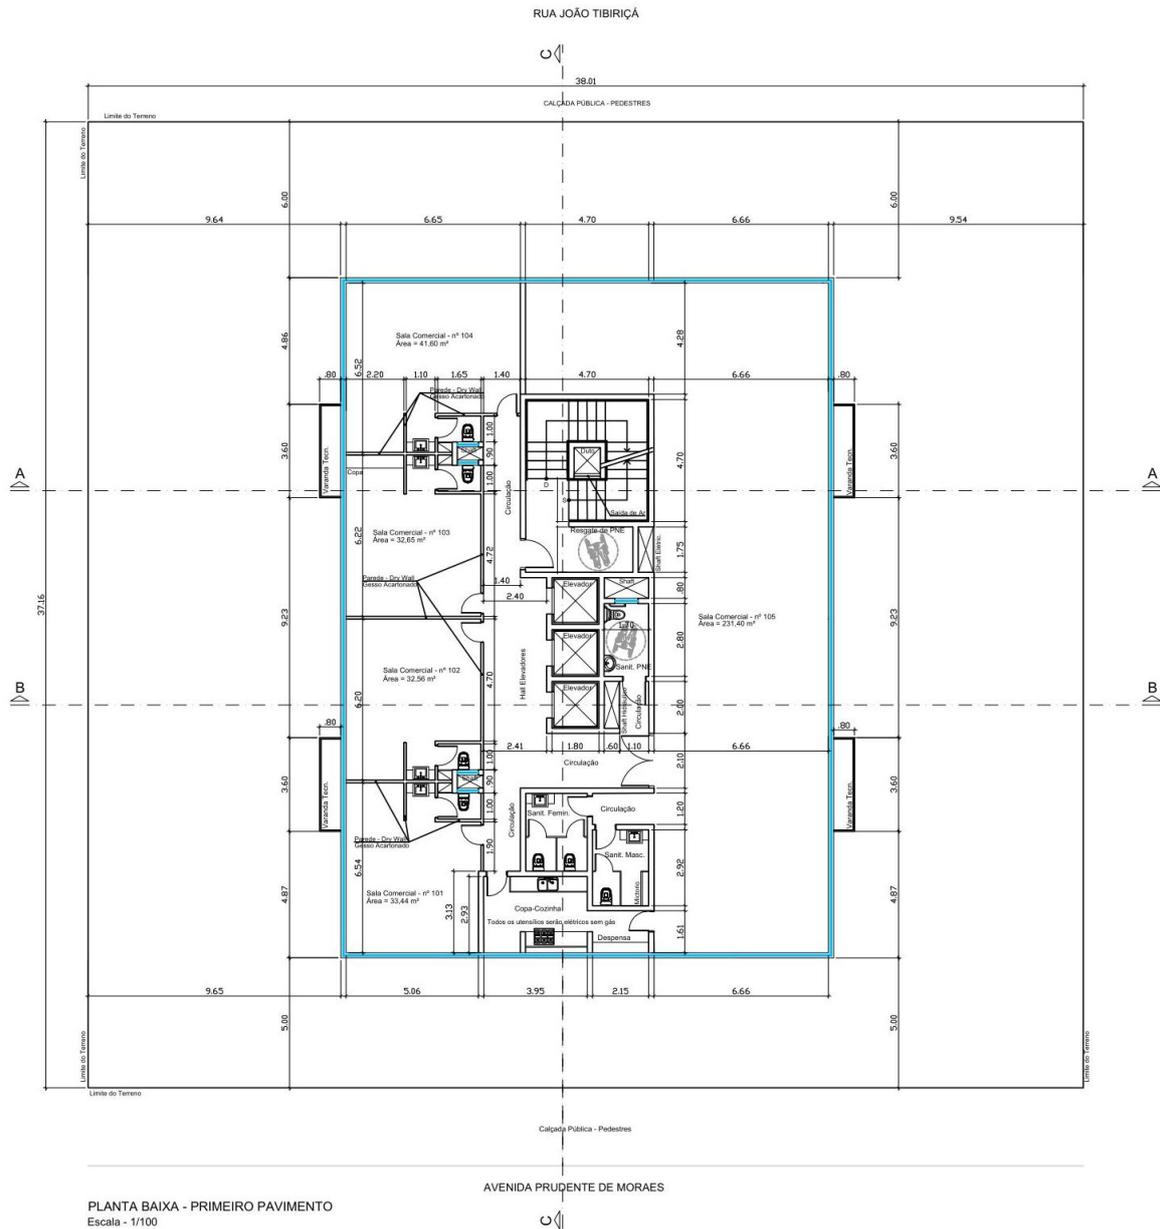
Projeto de implantação do empreendimento: primeiro pavimento.
